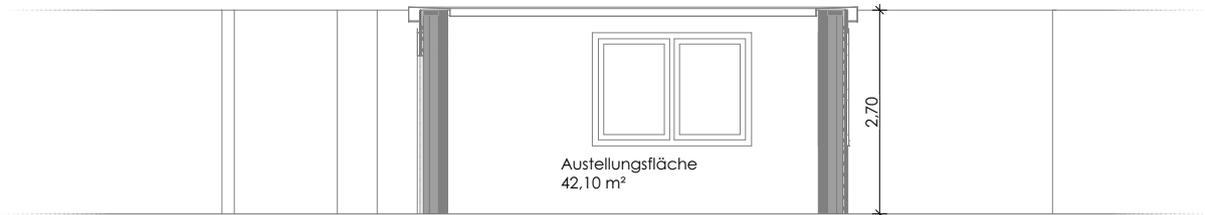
Grundriss 1:50 [eigene Darstellung]
